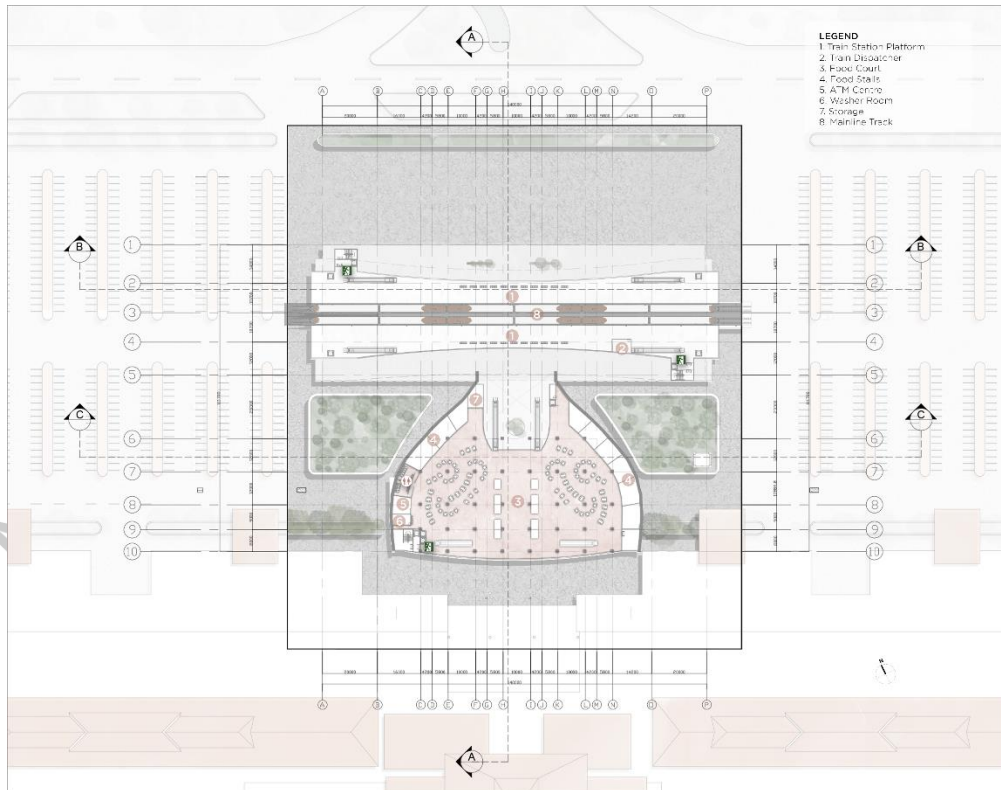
2 Denah Lantai 1 Juanda Intermodal Hub
